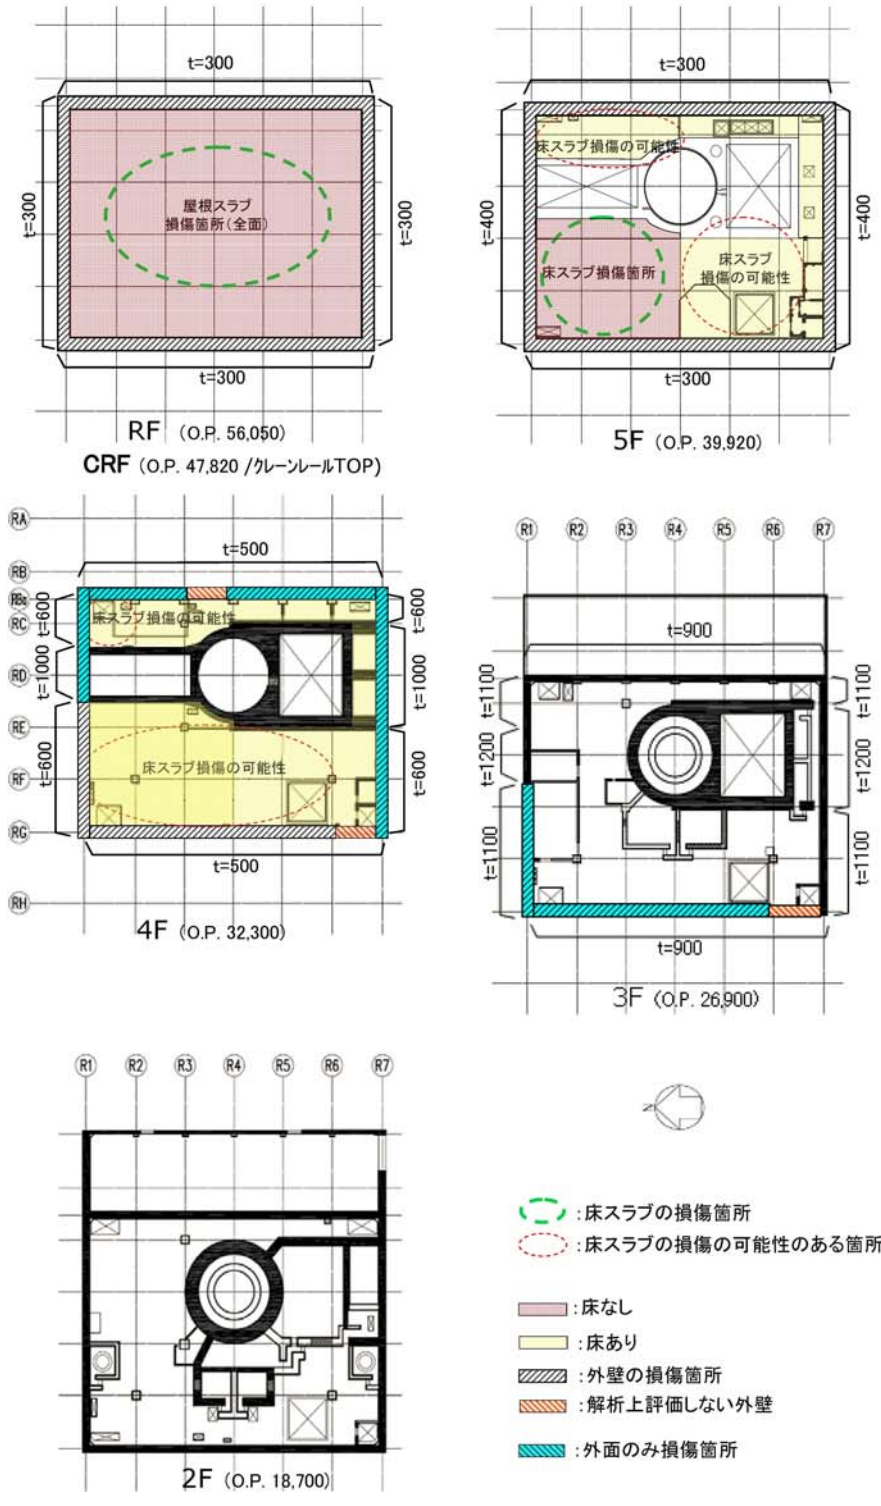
3号機原子炉建屋の損傷状況 (平面図)
